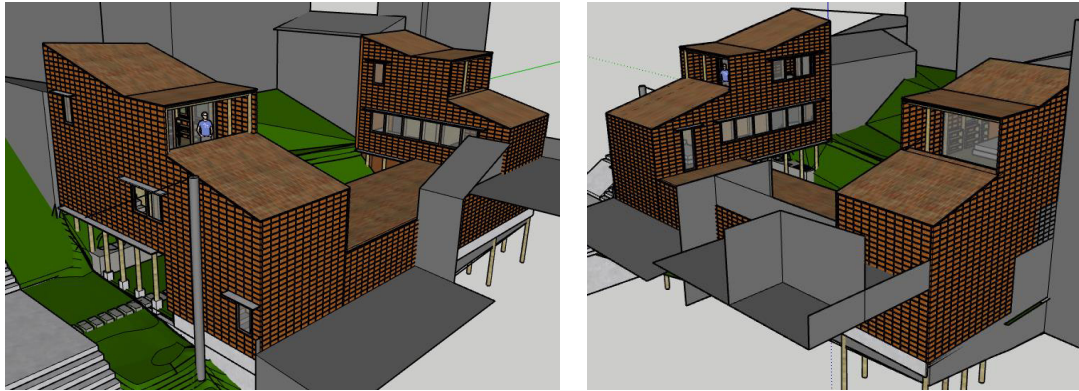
Planos arquitectónicos de la vivienda a construirse en el barrio de La Vicentina
